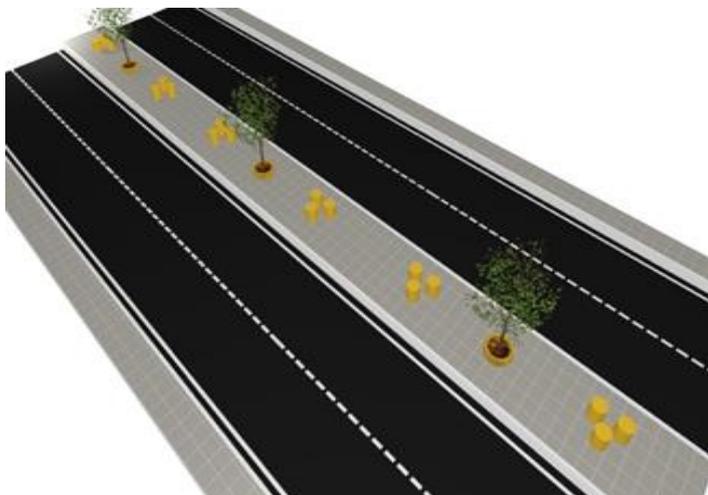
Canteiro central da Avenida Getúlio Vargas com as placas pré-moldadas de concreto com PET, vista em 3D.
